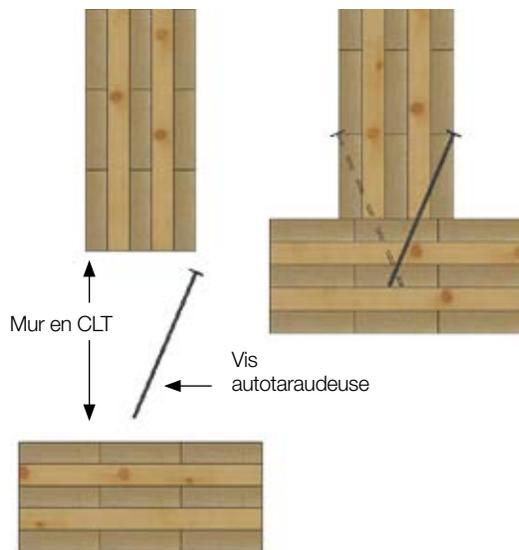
• Exemples d'assemblage de panneaux en CLT pour les planchers et les toits.
